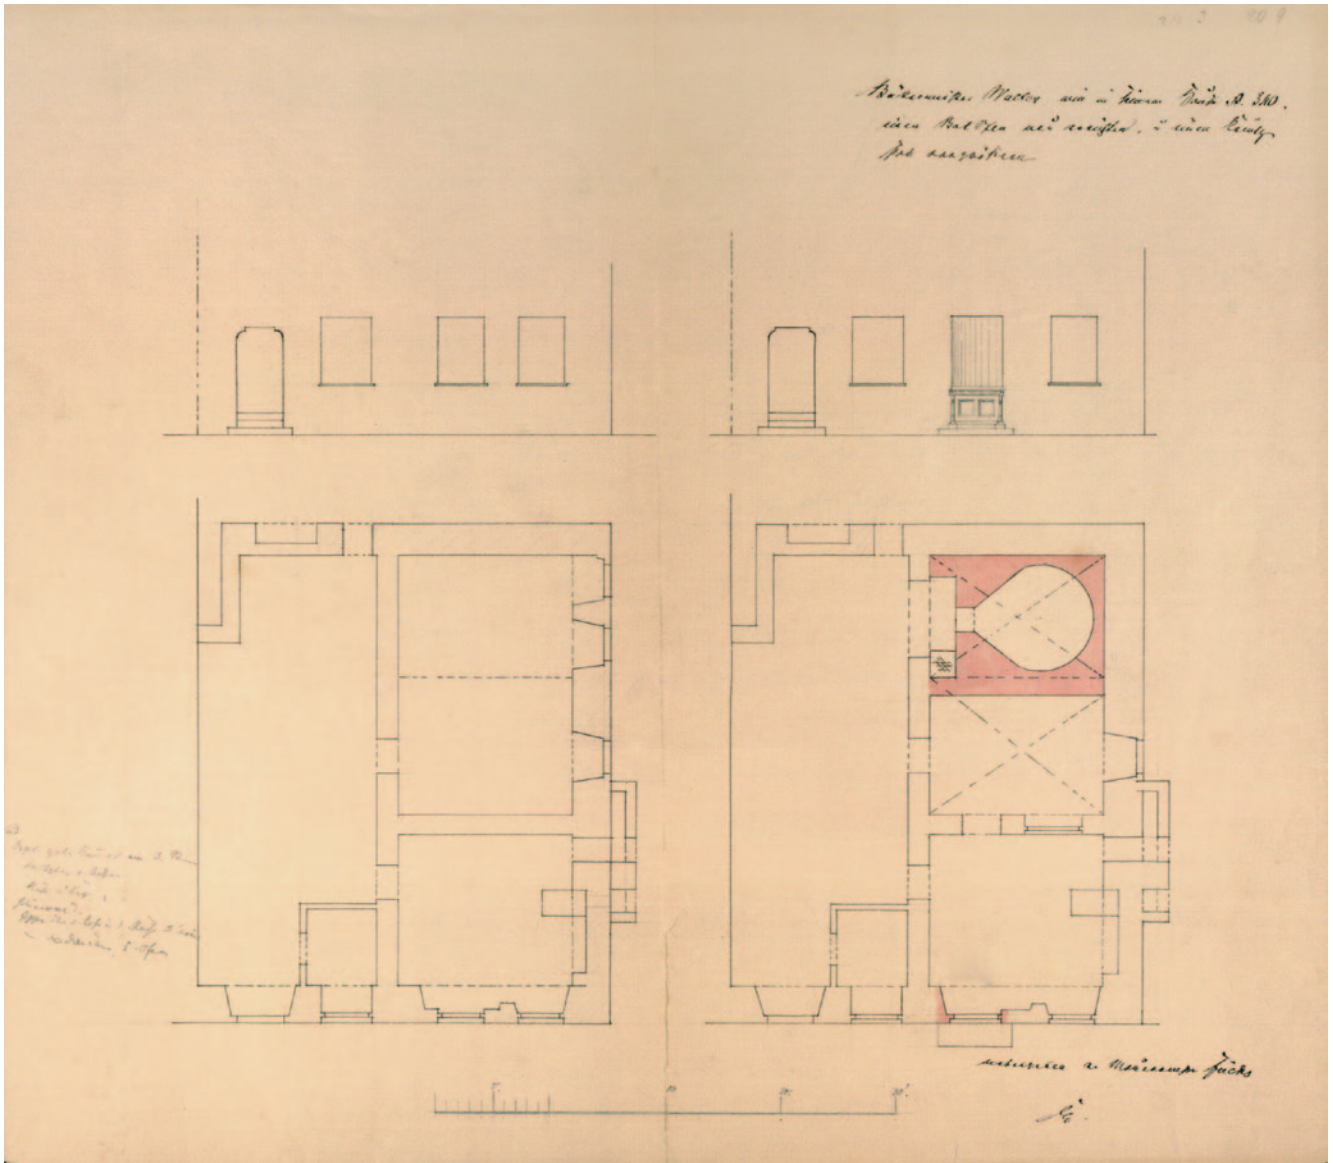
Gebäude Marktplatz 3 (A 340), Erdgeschossgrundriss und Teilansicht, Baugesuch zur Einrichtung eines Bäckerladens 1856.
